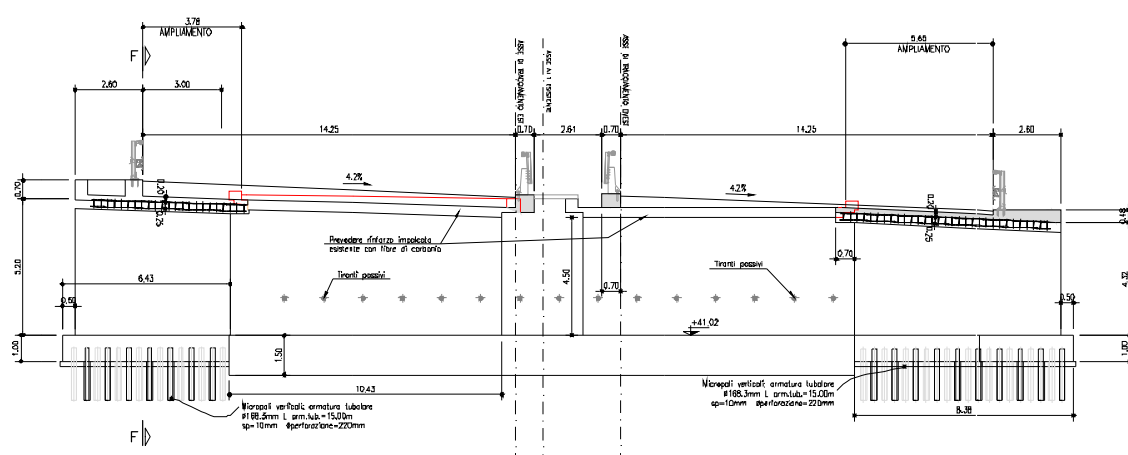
Viadotto sul F. Iolo. Sezione trasversale
